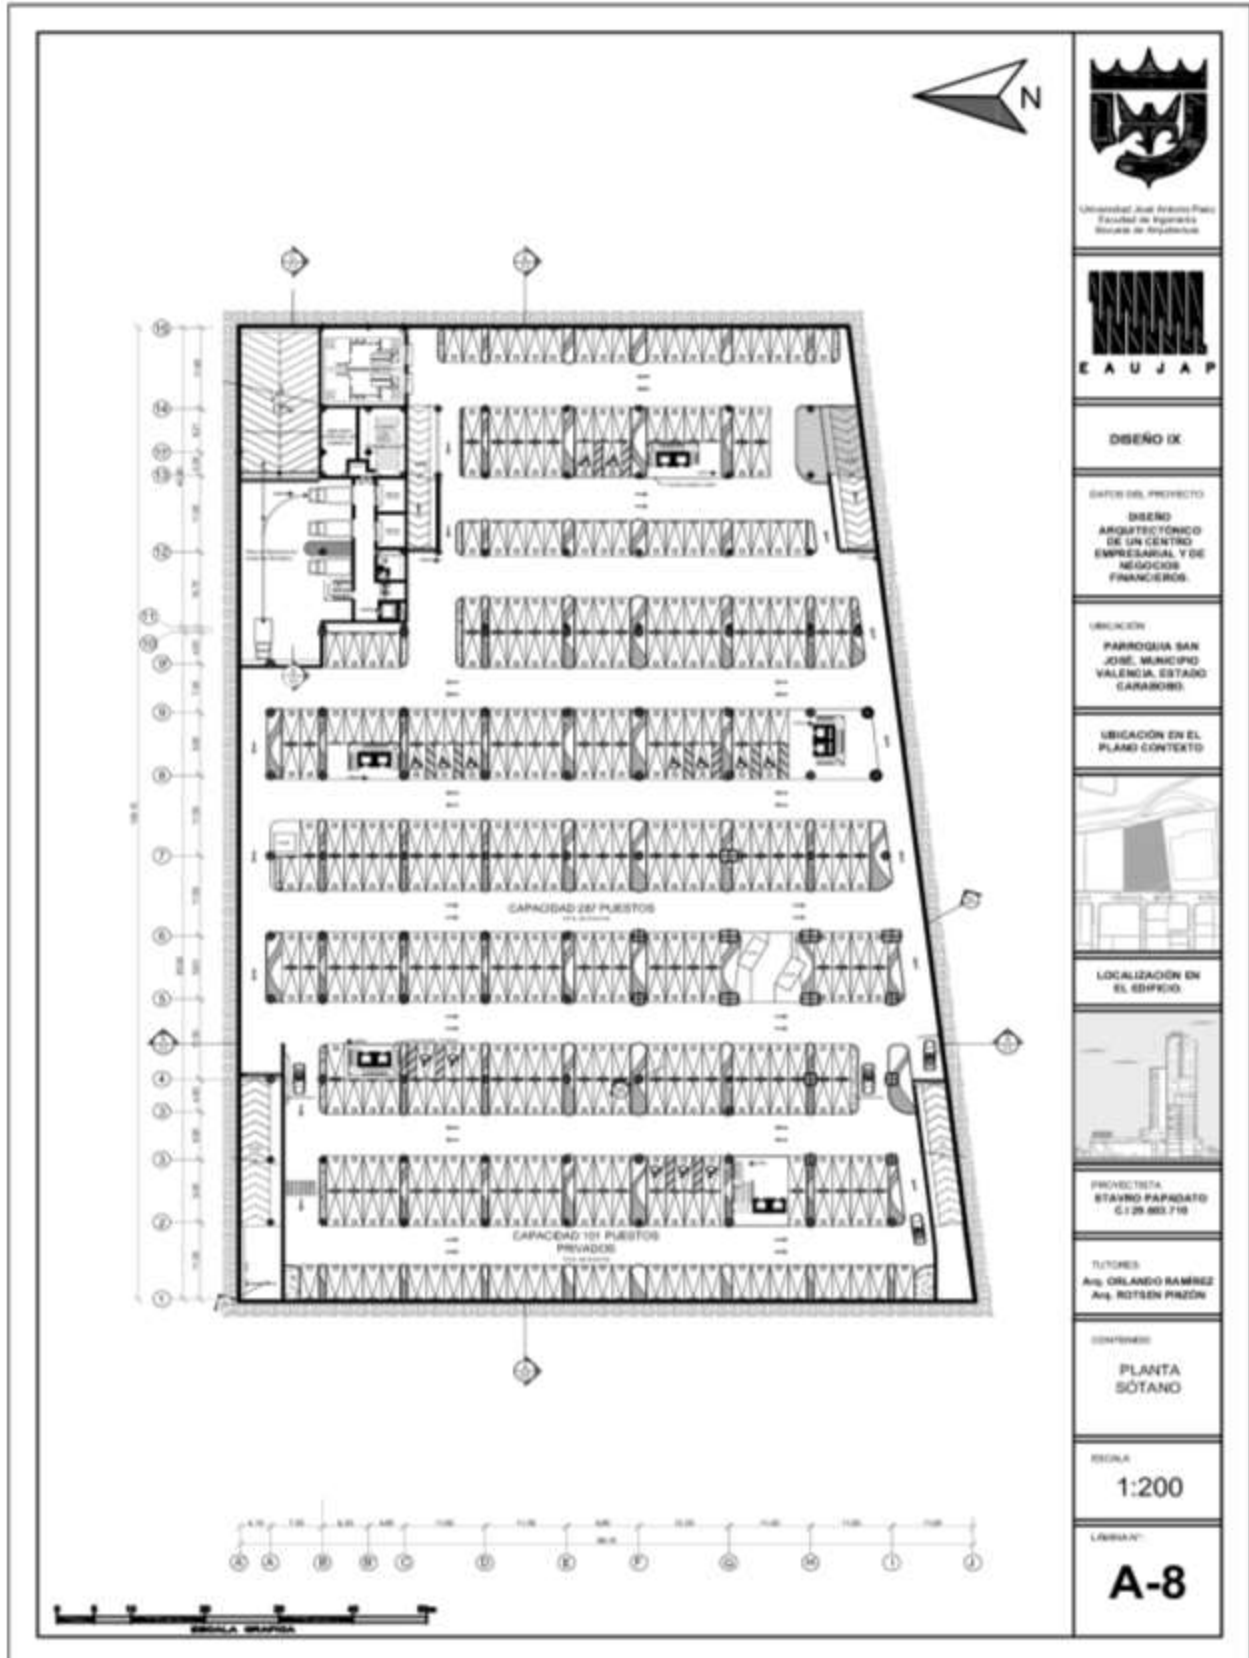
A – 8 Planta Sótano Fuente: El Autor (2023)
